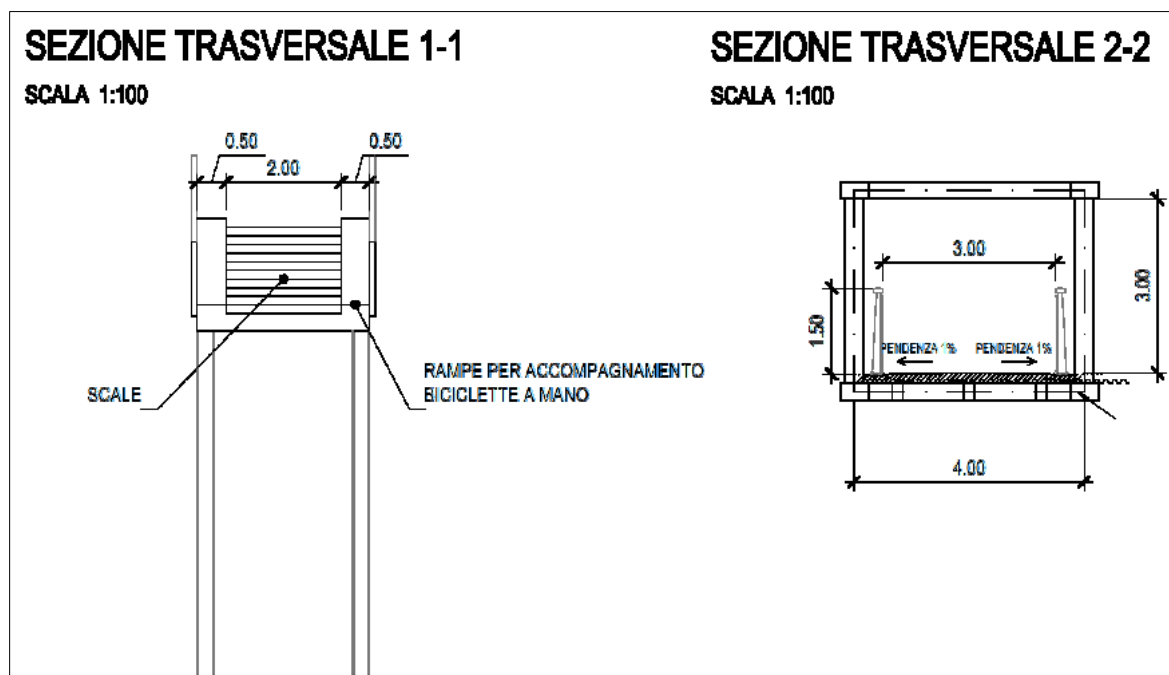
sezione rampe di accesso e passerella pedonale.
